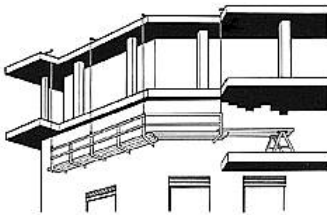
Apoyo incorrecto del andamio de borriquetas en andamio colgado
